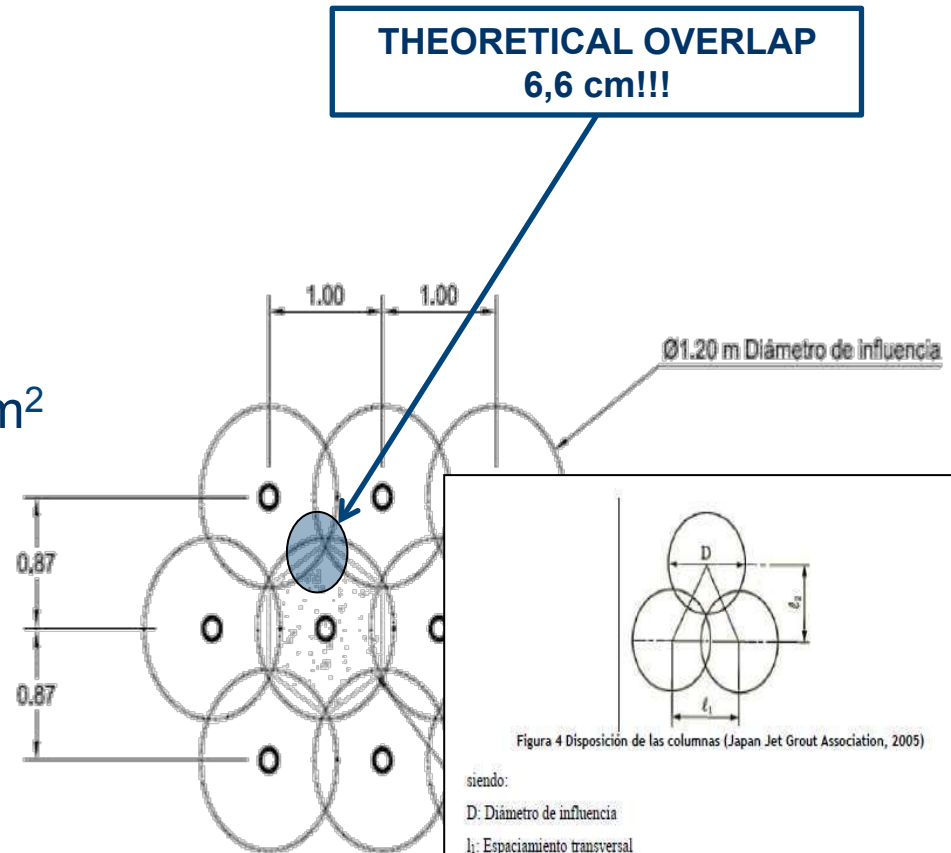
Disposición de las columnas (Japan Jet Grout Association, 2005)
